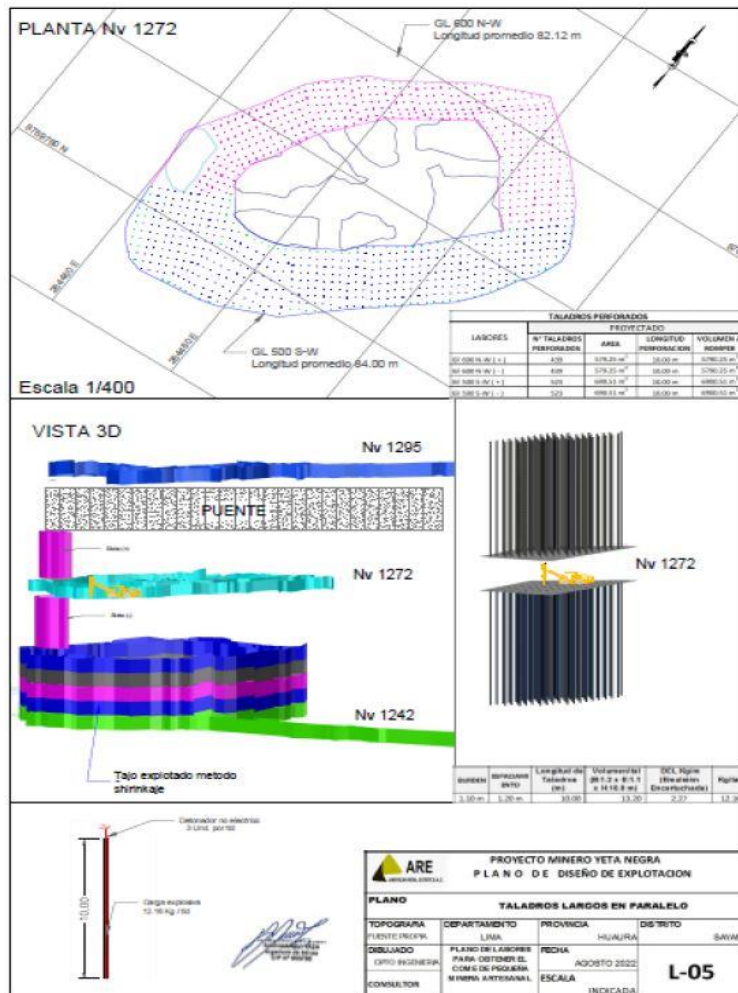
Plano en planta y perfil, subnivel con taladros largos Tomada del departamento de Planeamiento
